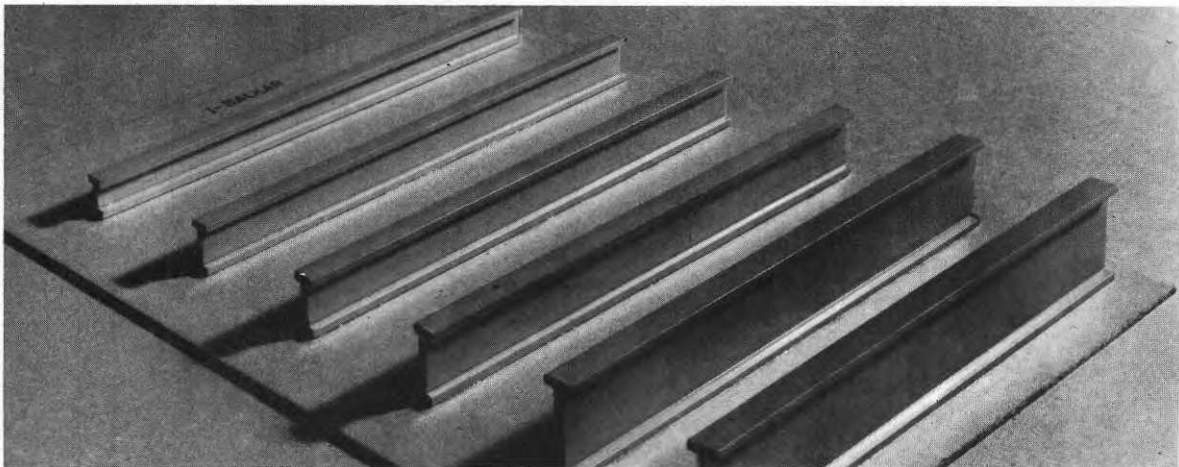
Modellkomponenter, prefabricerade betongelement.
